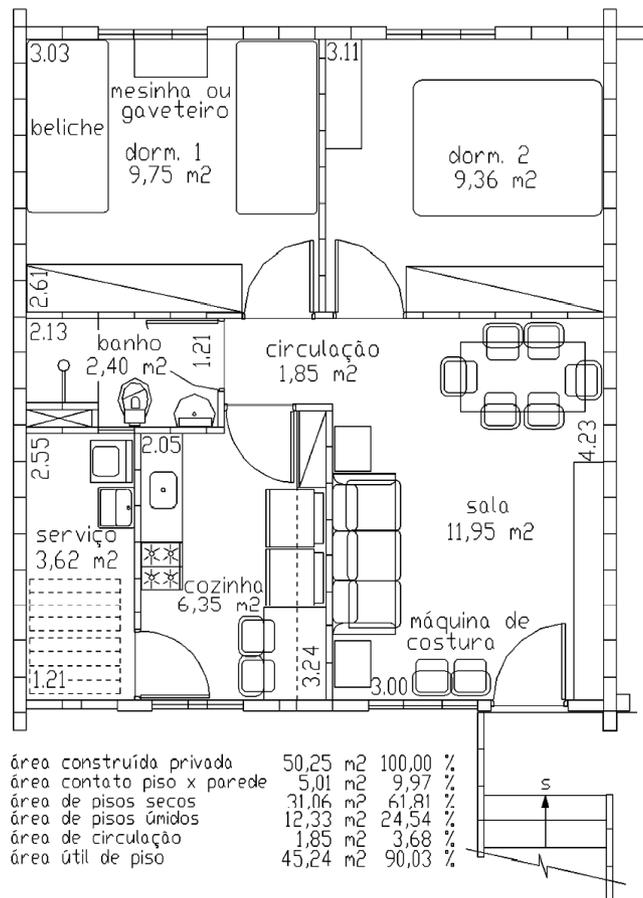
Planta 8 – Projeto alterado com área expandida e alterações no setor hidráulico
